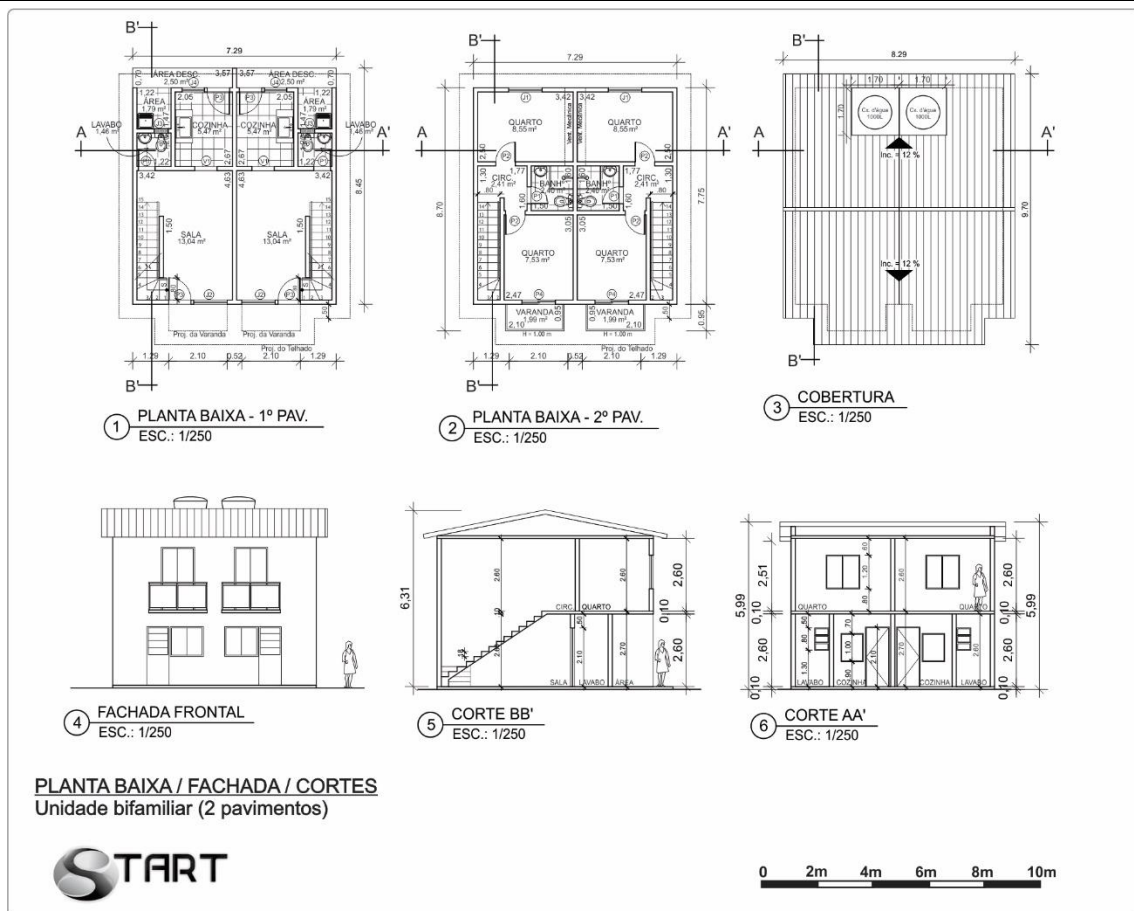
Planta baixa, fachada e cortes da unidade bifamiliar de 2 pavimentos
